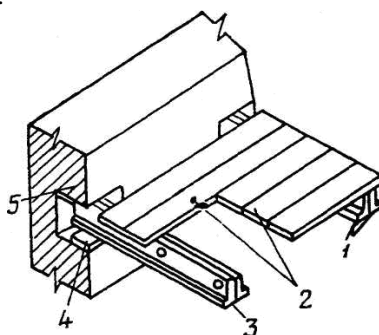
Збірний залізобетонний балкон одеської конструкції:
